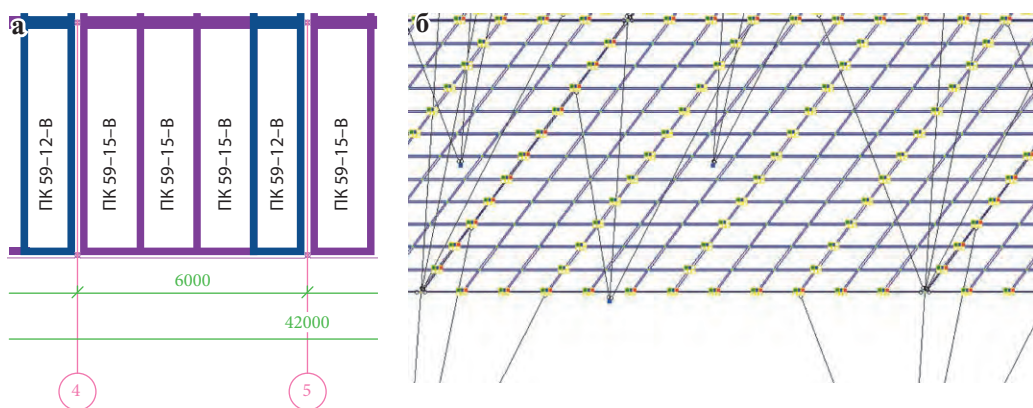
Расчетная схема перекрытия со сборными железобетонными плитами при использовании конечных элементов оболочек: а) схема расположения сборных плит; б) расчетная схема
